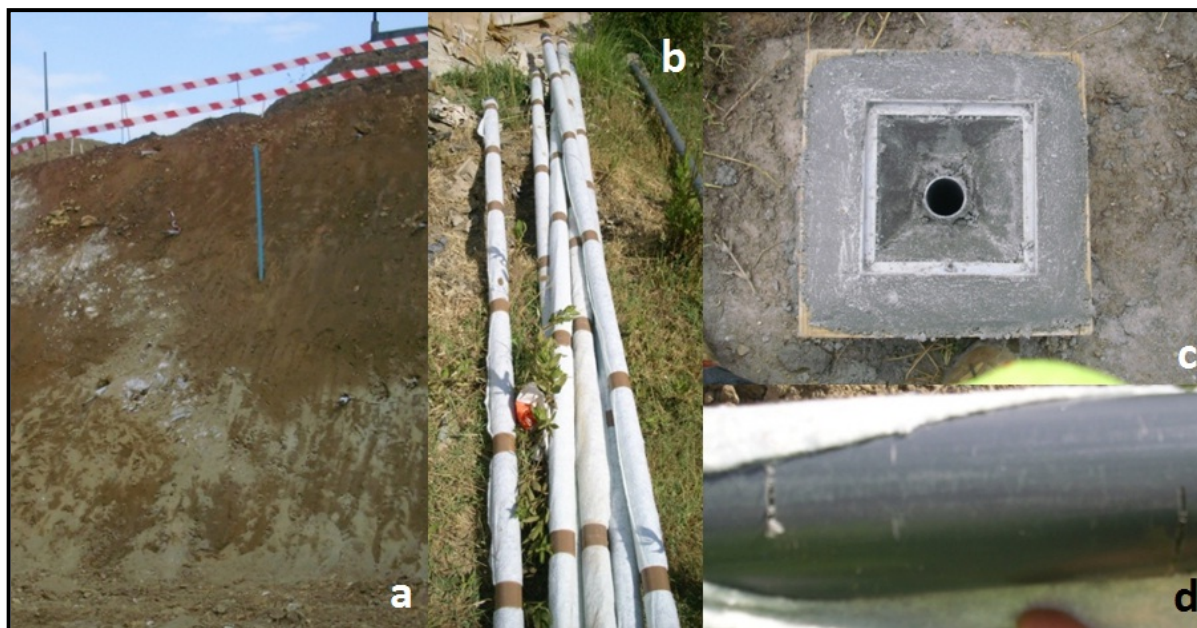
a – Piezómetro colocado em local inacessível; b – tubos de pvc envolvidos em membrana de geotextil; c – Piezometro totalmente instalado; d – tubo crepinado utilizado.
